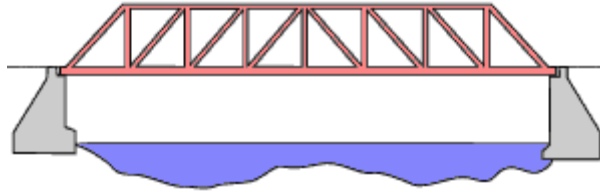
Schéma d'un pont en poutres en treillis type Howe
